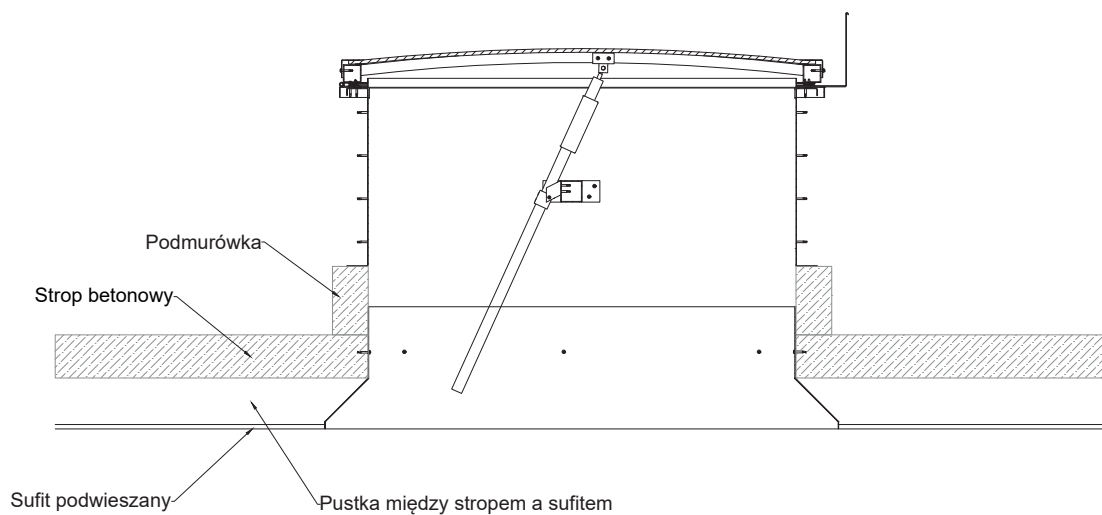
Przekrój klapy z termoizolacją dla montażu do stropu betonowego z wyniesieniem/podmurówką.
